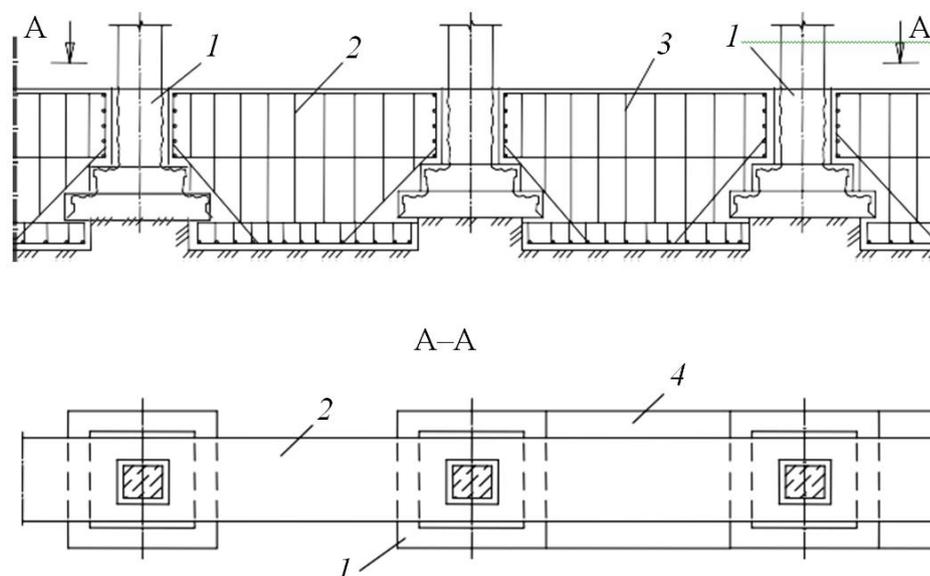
Переустройство столбчатых фундаментов в ленточные: 1 – столбчатый фундамент; 2 – железобетонная перемычка; 3 – арматурные каркасы; 4 – уширенная часть перемычки
